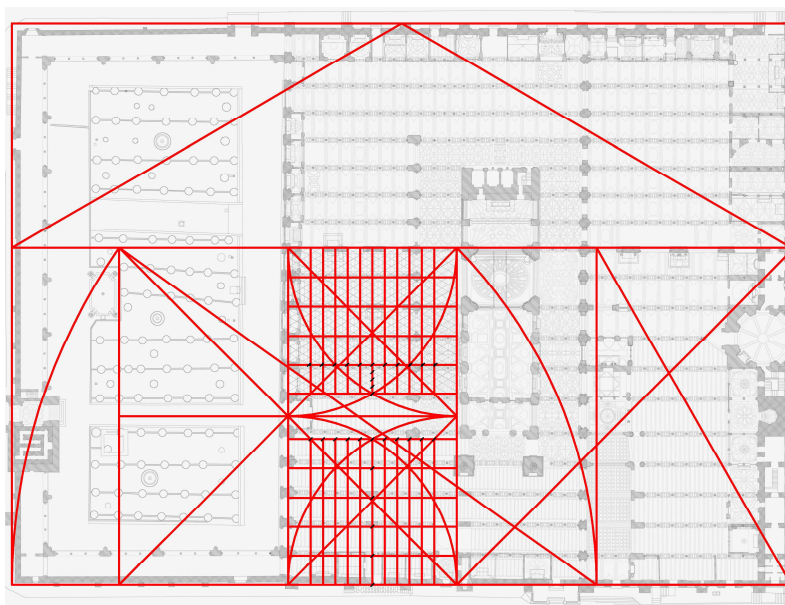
Restitución del trazado de planta de la Mezquita según Fernández Puertas
